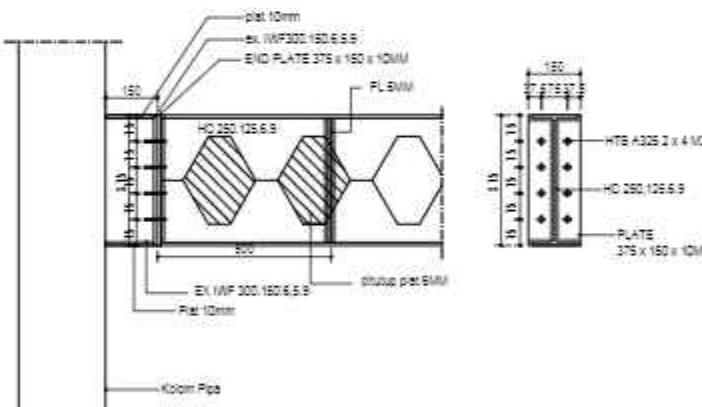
DETAIL HUB. BALOK HC 350 KE KOLOM PIPA
